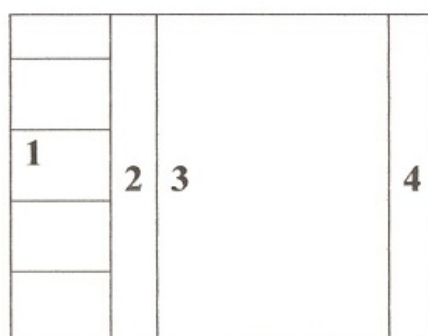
Расчетная схема ограждающей конструкции: 1 – кирпичная кладка в $\frac{1}{2}$ кирпича; 2 – воздушная прослойка; 3 – фибропенобетонный блок; 4 – гипсоперлитовая штукатурка.
